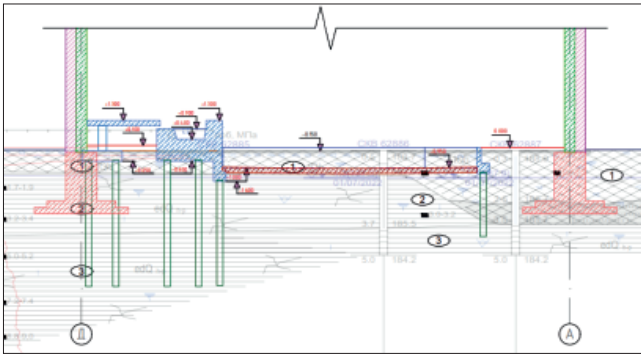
Поперечный разрез промышленного железобетонного каркаса с указанием встраиваемых объектов в эксплуатируемое сооружение
